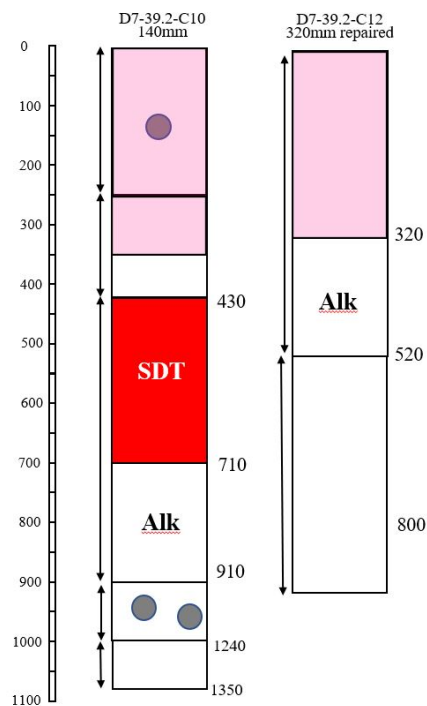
Plan d'essai D7-39-2 - Fournier et al, 2024
